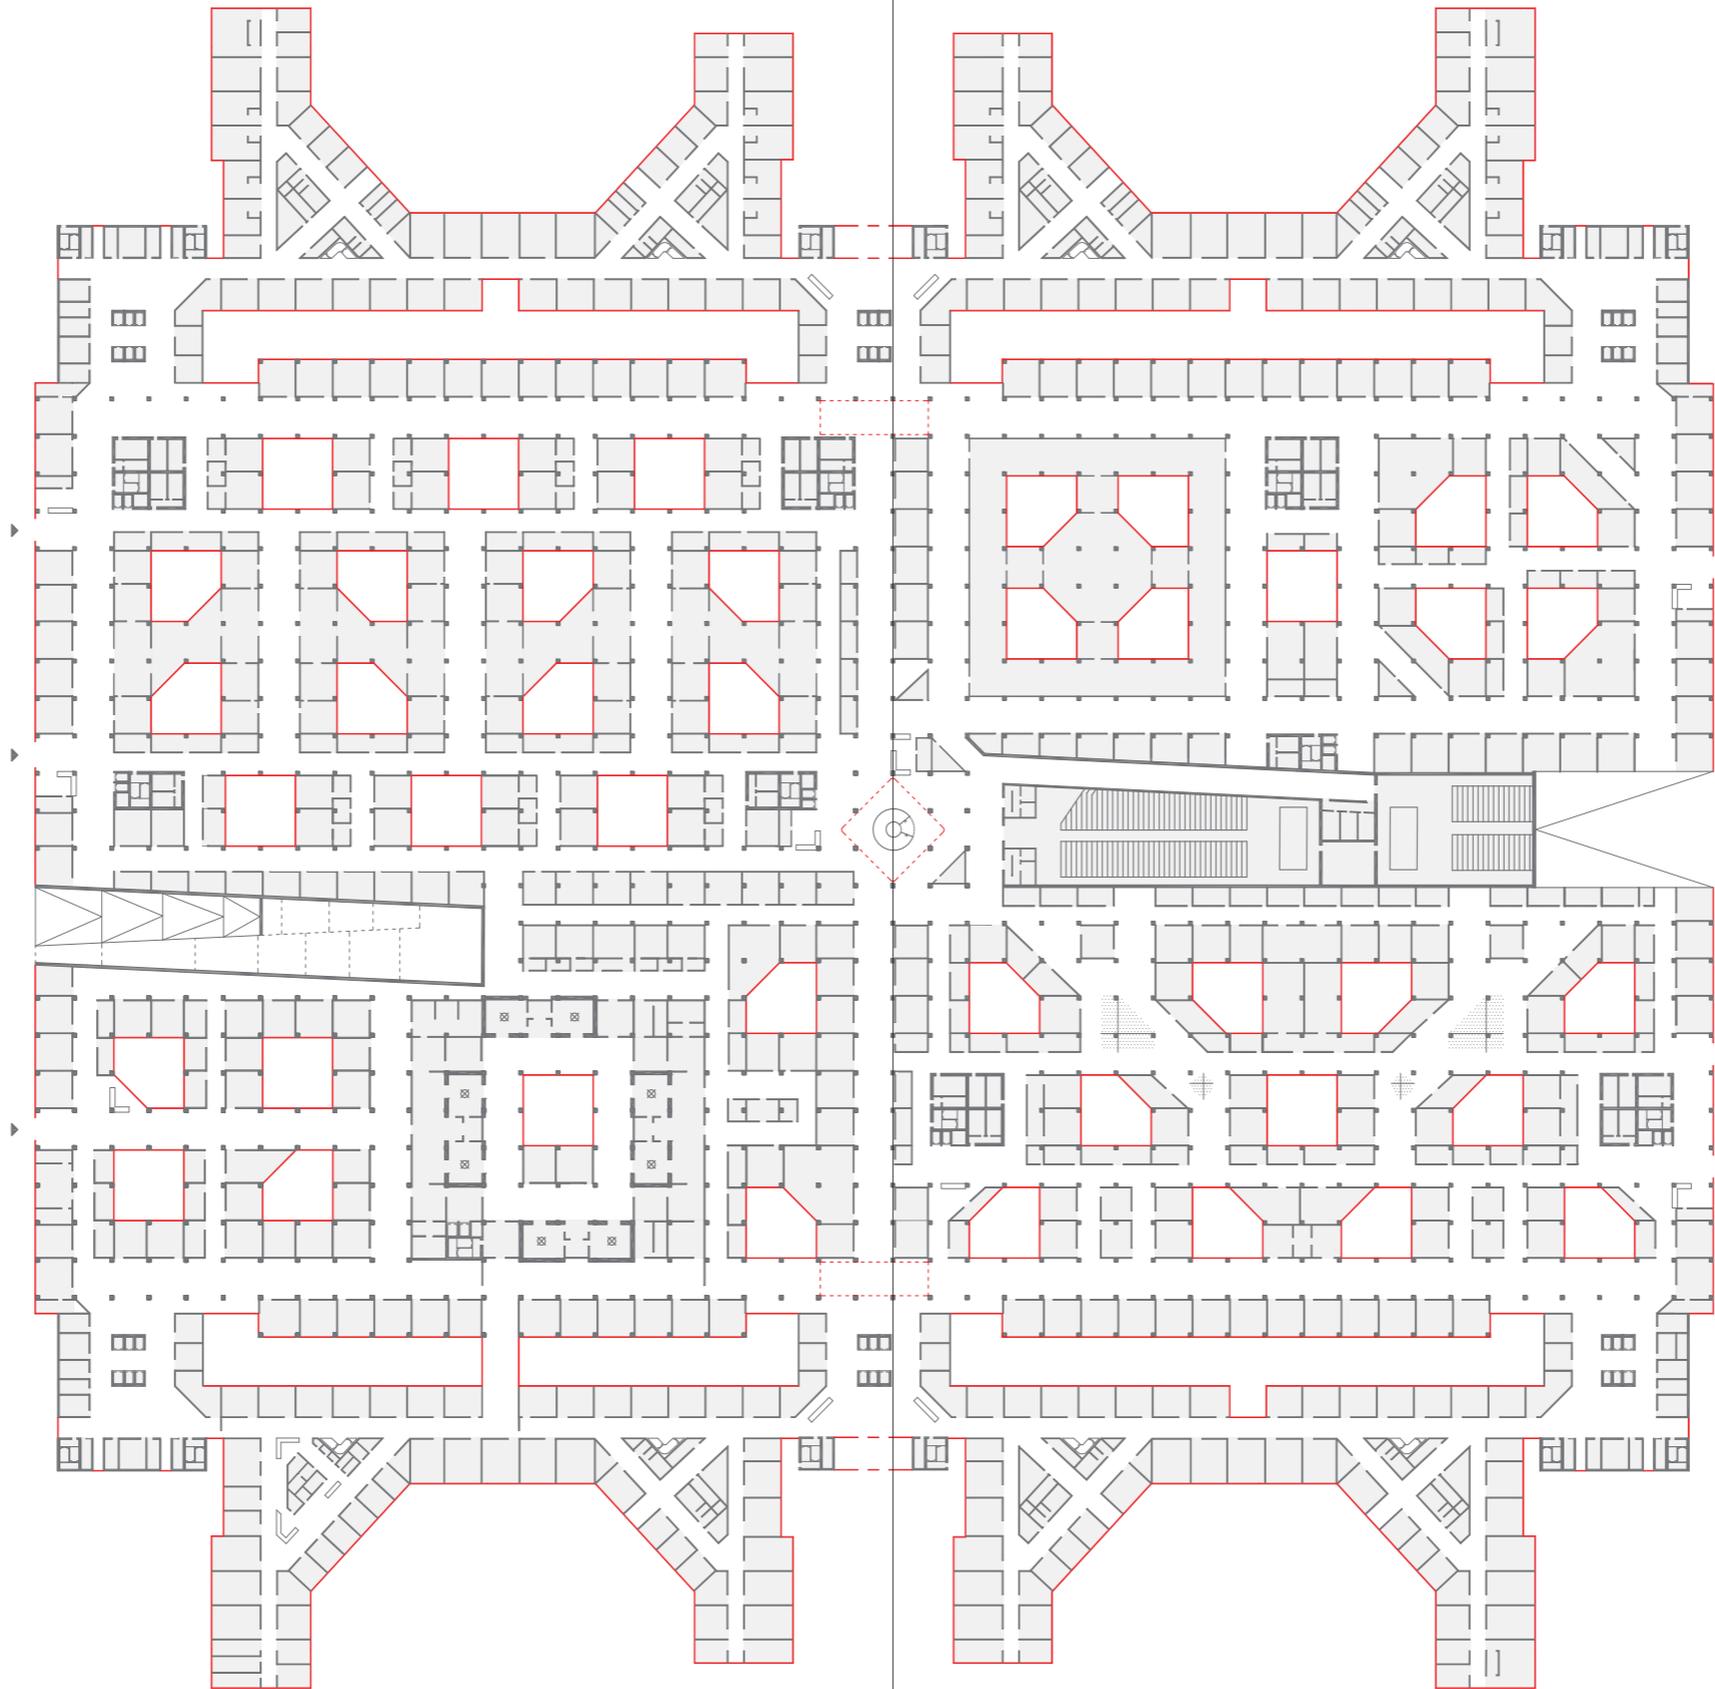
Grundriss Erdgeschoss, M.1:1600
